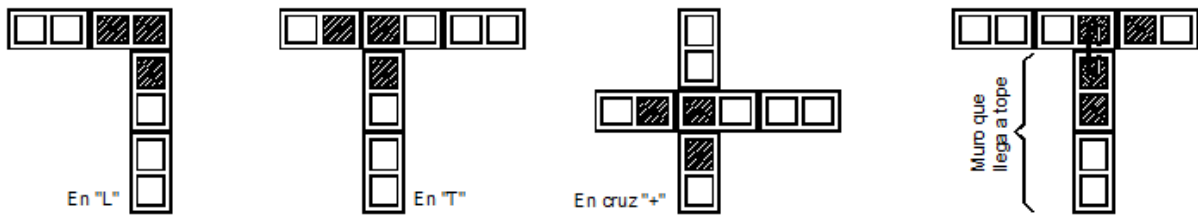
Refuerzo en los extremos de los muros e intersecciones
